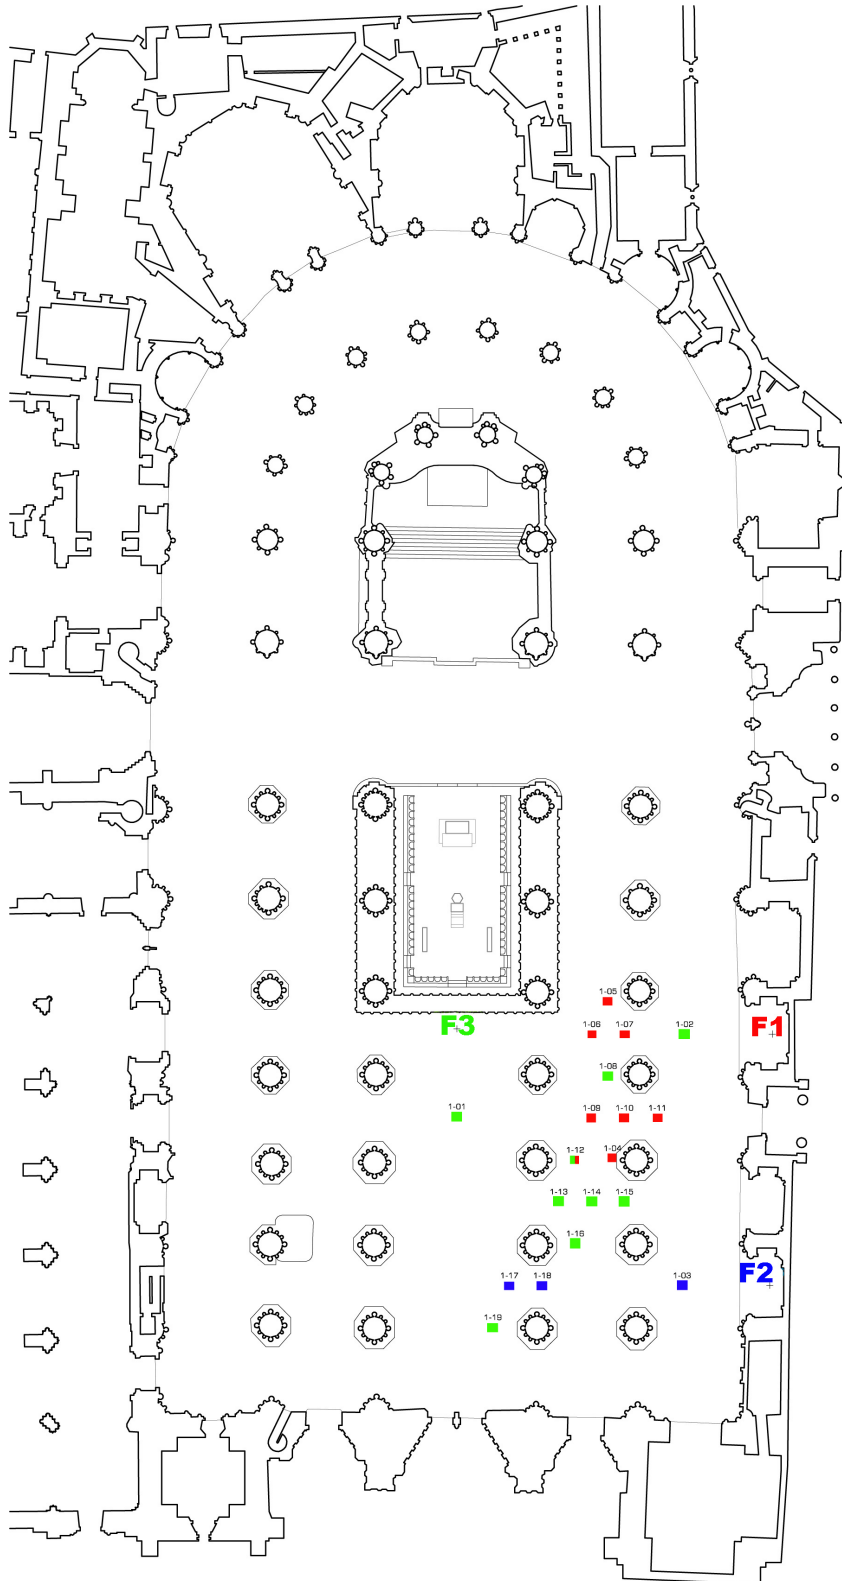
Planta de la Catedral marcada con las fuentes predominantes
